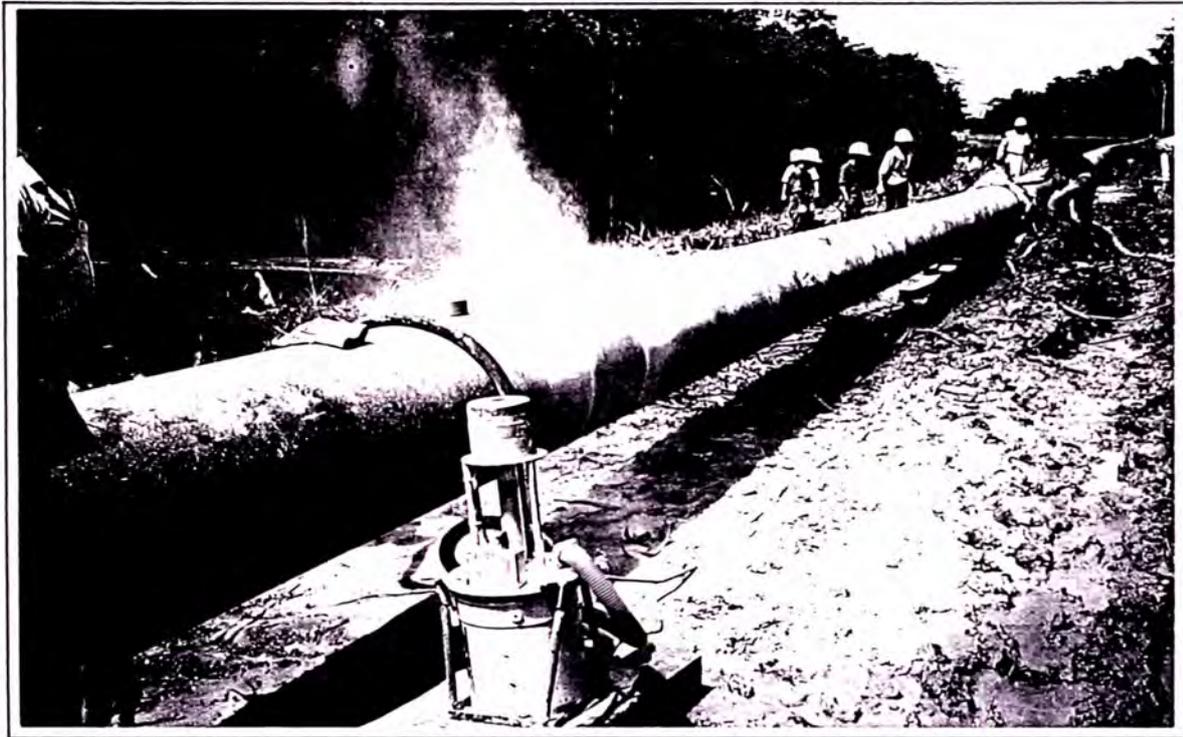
Aplicación de polvo epóxico parte posterior-inferior del tubo.
